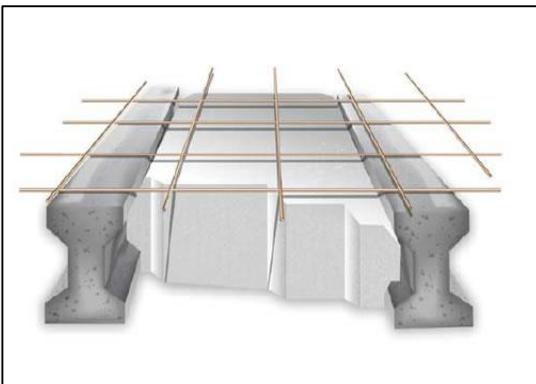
Sistema Vigueta y Casetón. Fuente: Aislapak 2017. Recuperado de: www.aislapak.com/construcción.html
